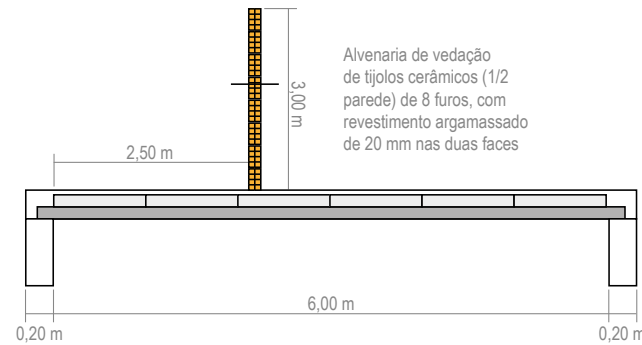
Esquema de laje para exemplo de dimensionamento
